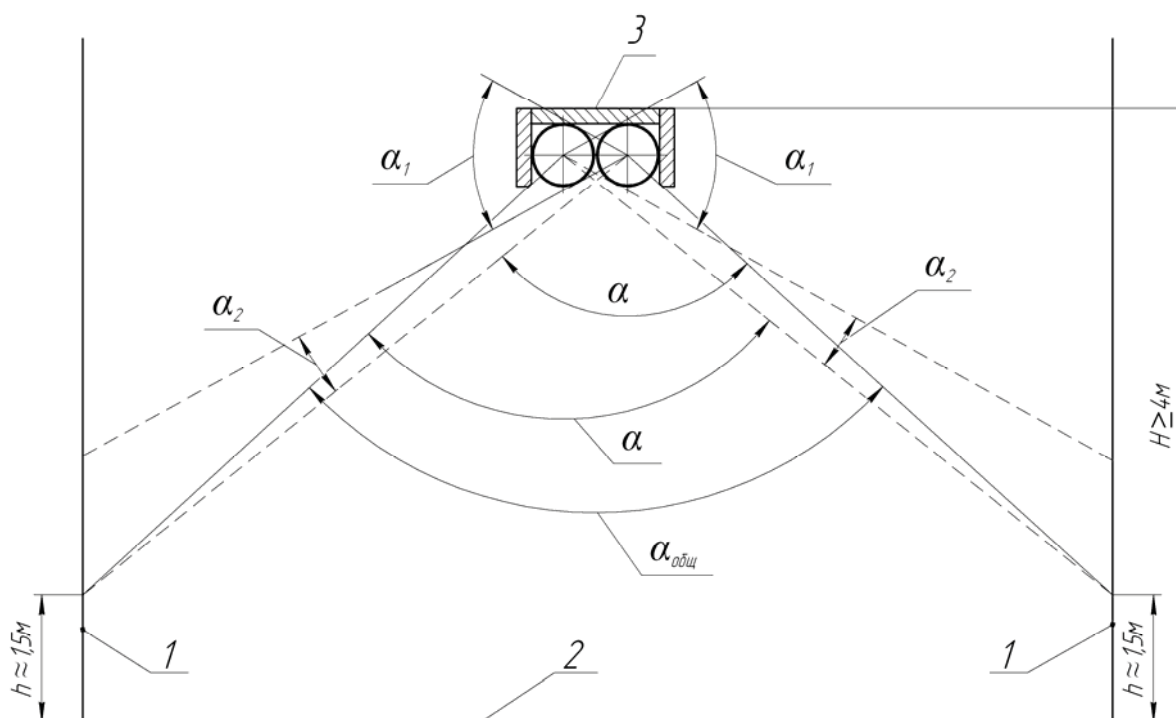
Схема инфракрасного отопления помещения с помощью одного двухтрубного ленточного нагревателя: 1 – стена помещения; 2 – пол; 3 – ленточный двухтрубный инфракрасный нагреватель
